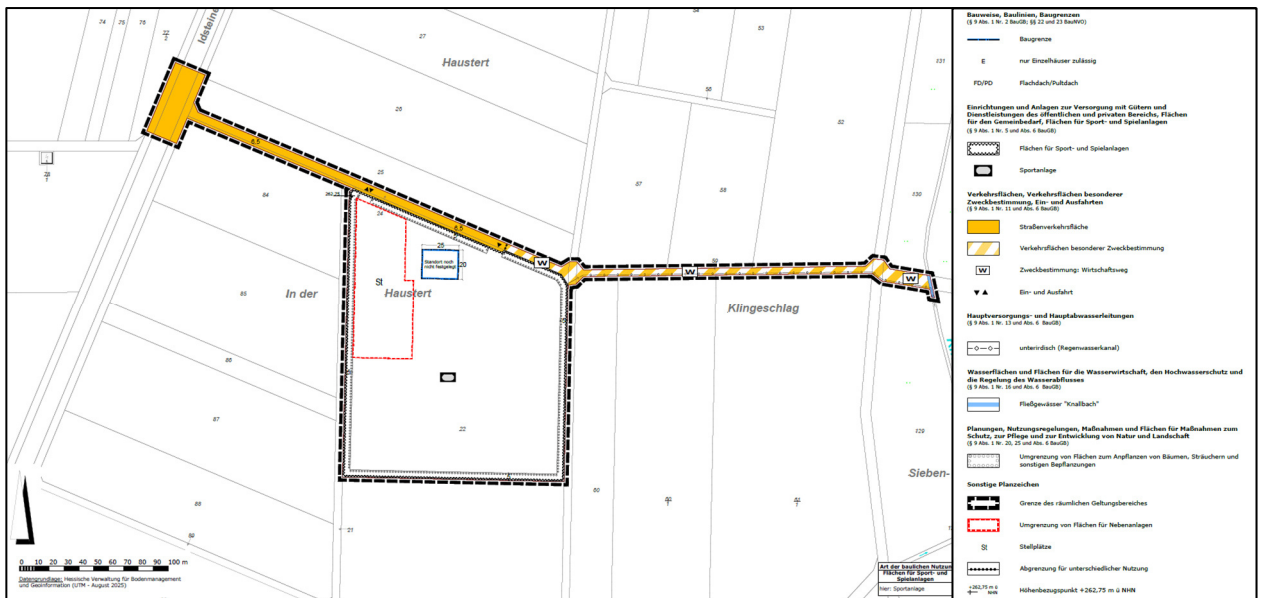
Ausschnitt aus dem Bebauungsplan „Sportanlage Walsdorf“ (PlanES, Planstand: 04.02.2026).
